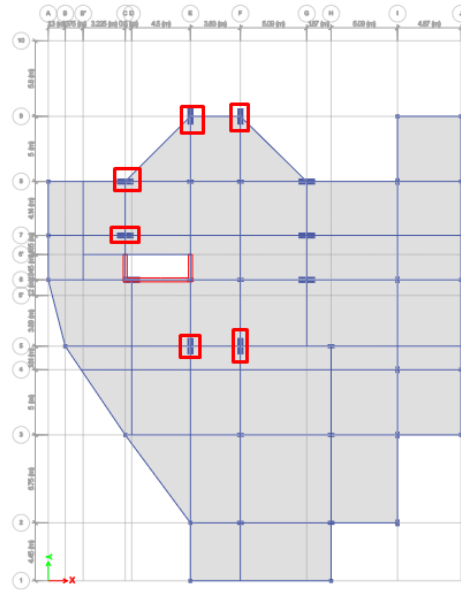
Localización de Columnas dispuestas en la Planta #4 a #18 para ensayo de esclerometría
